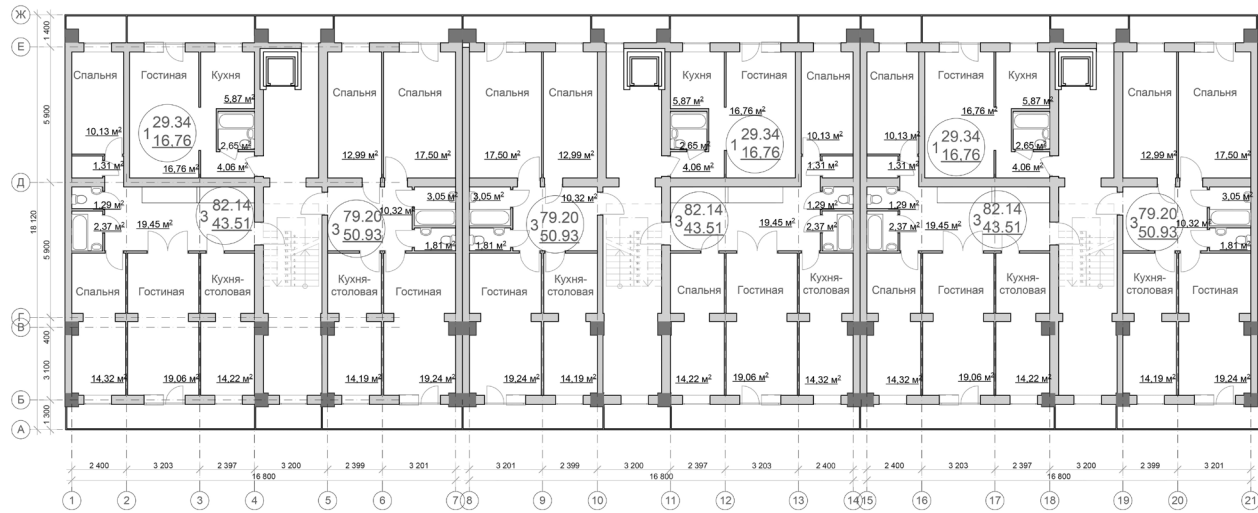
План типового этажа. Реконструкция с надстройкой пяти этажей
